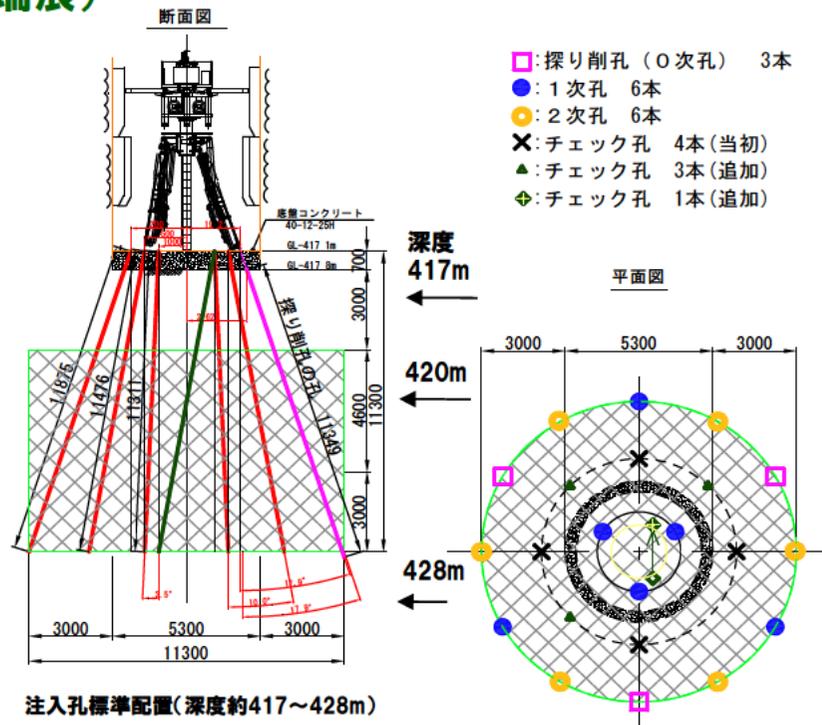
立坑に適用したグラウト孔の配置図(左:断面図, 右:平面図)
